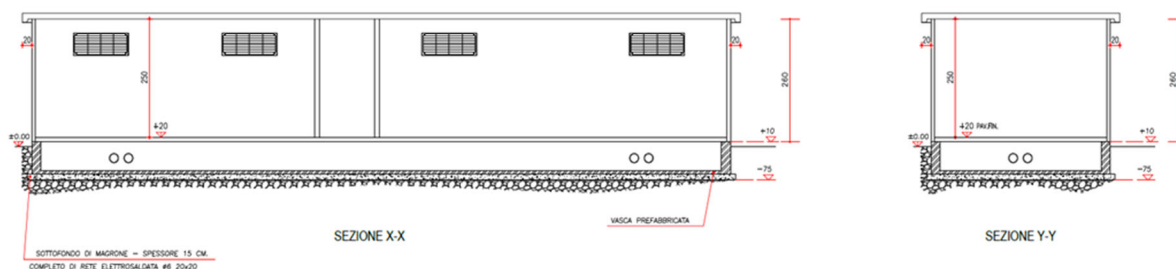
Prospetti e Sezioni Cabina di Raccolta MT
